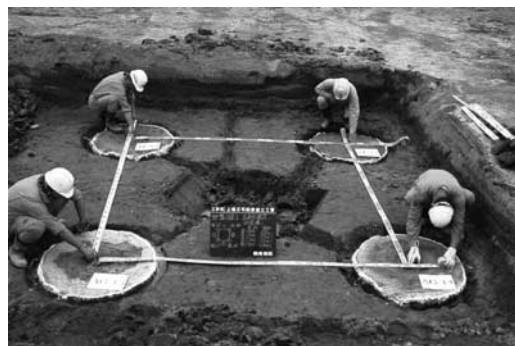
大口径施工（手前：φ1300 mm）の改良杭頭
